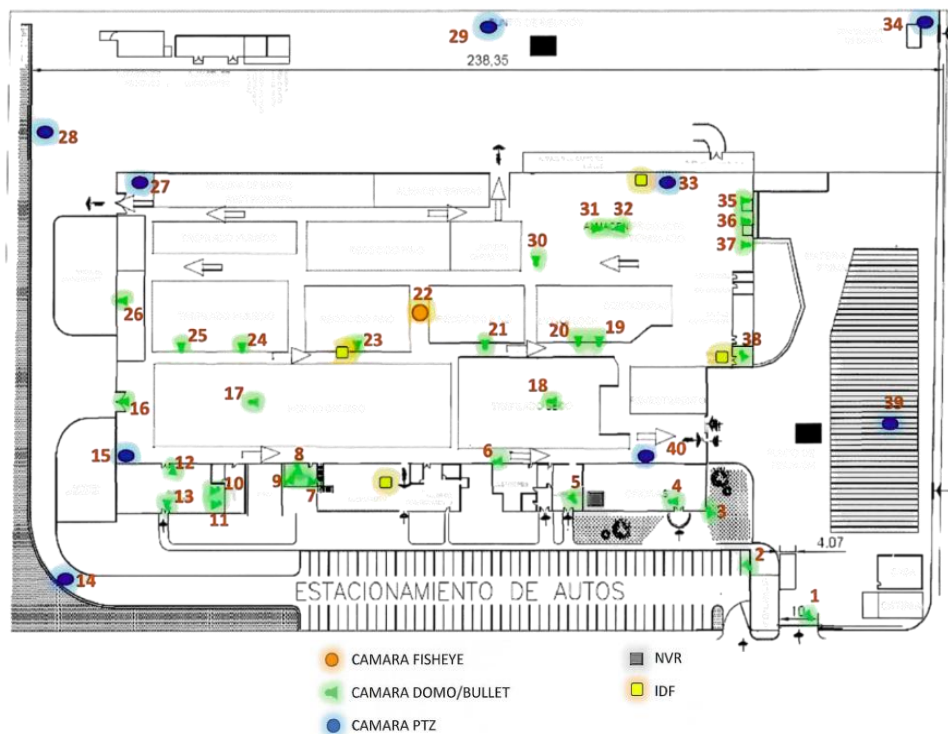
Plano general de ubicación de cámaras en planta. Recuperado del archivo proporcionado por la empresa.
